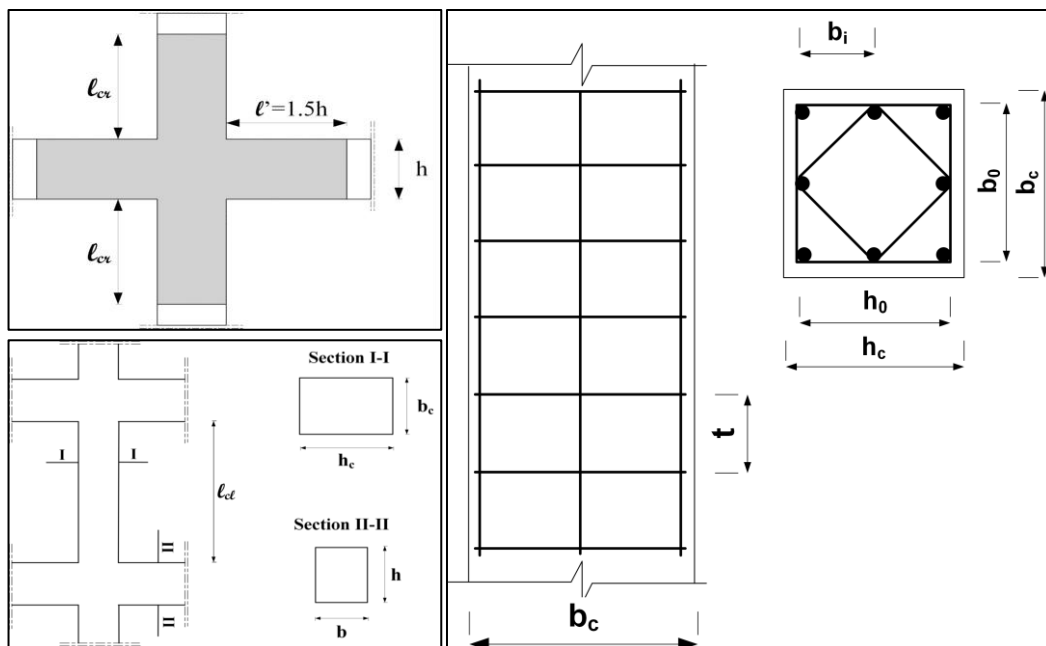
Détails d'armatures longitudinales des poteaux RPA 2024
